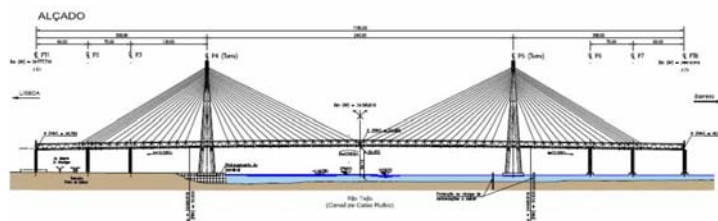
Alçado solução Chelas – Barreiro [28]
